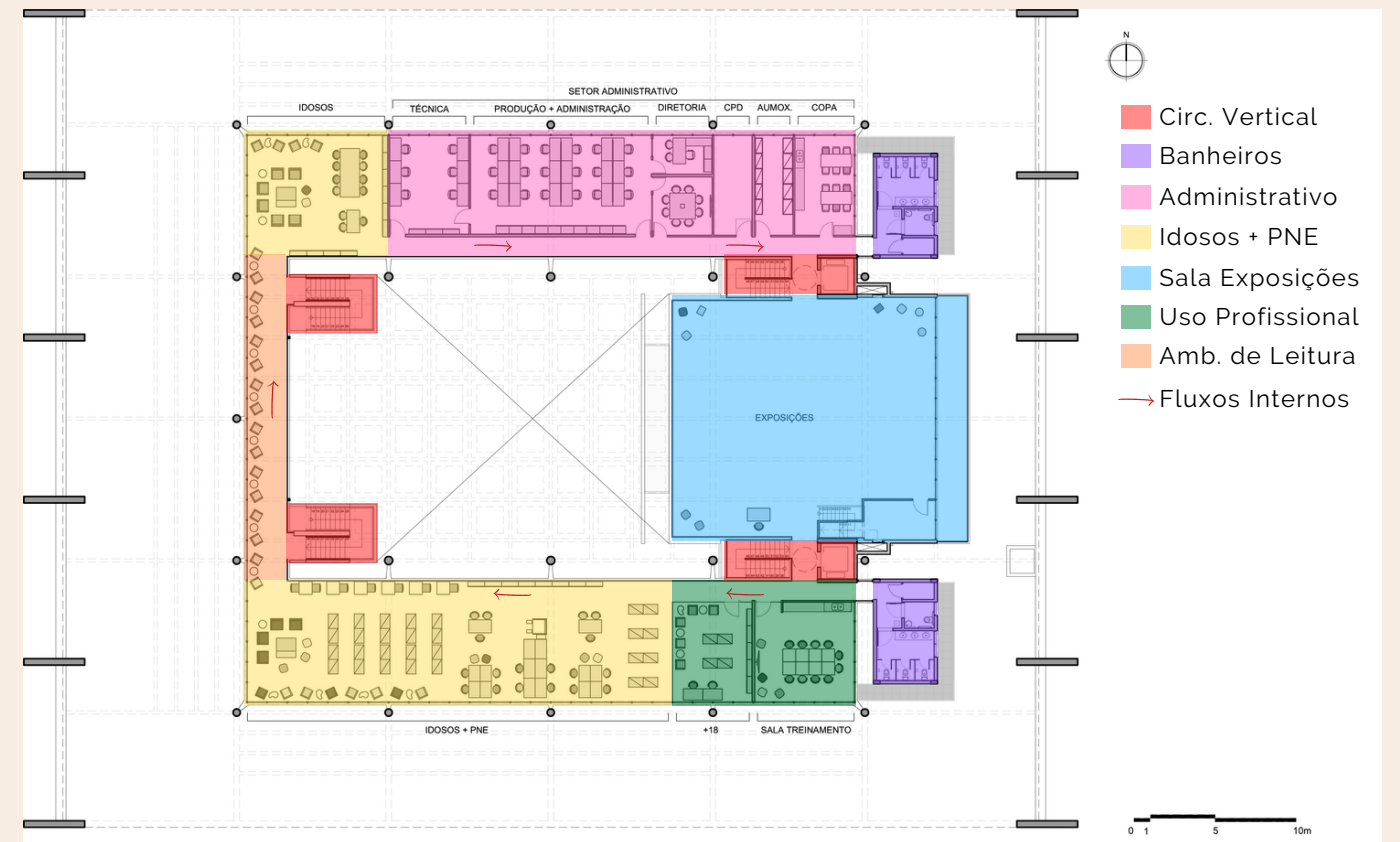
Fluxo e Setorização do Segundo Pavimento BVL
